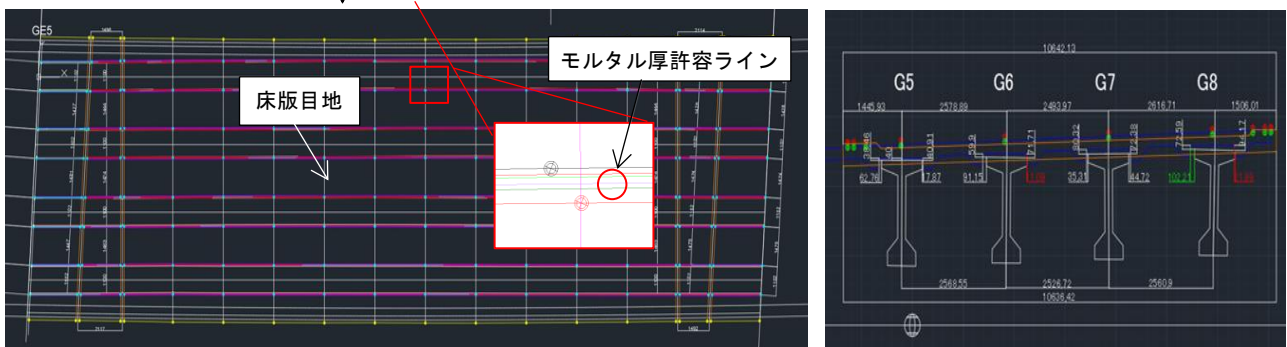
主桁形状のシミュレーション例 (平面図と断面図)
